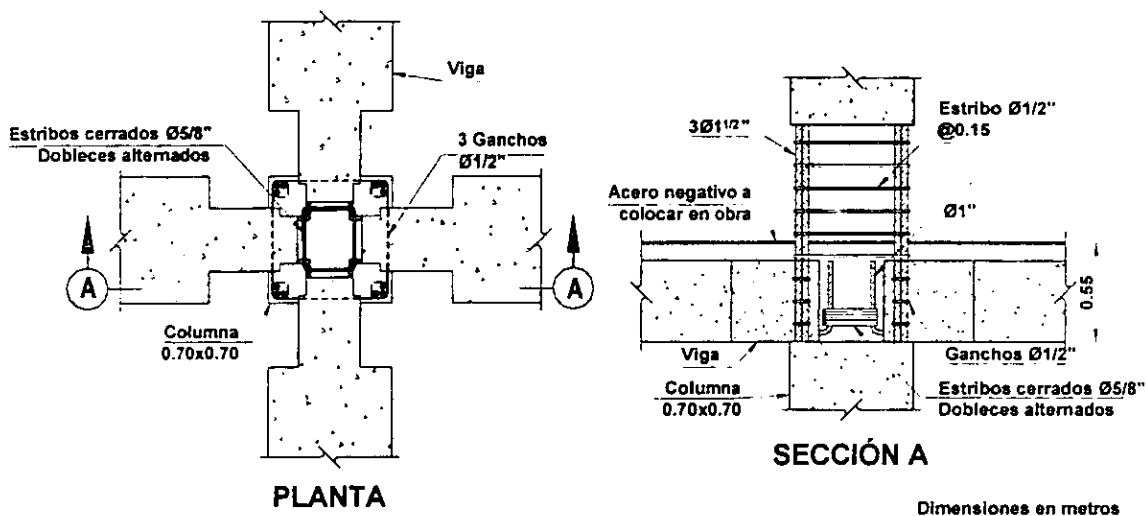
Conexión viga-columna (Carranza, 1997)
